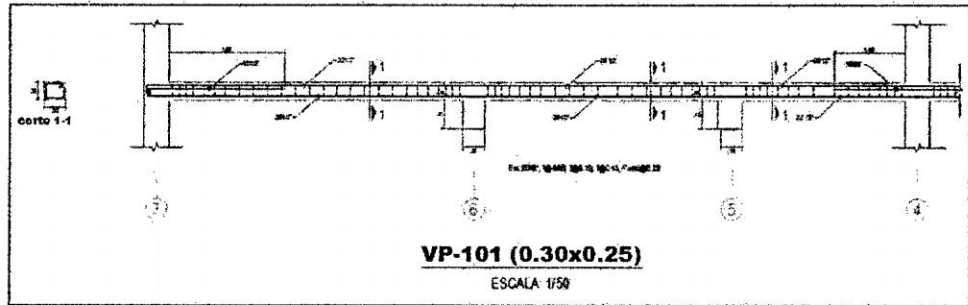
Armadura de la viga Longitudinal del primer piso
